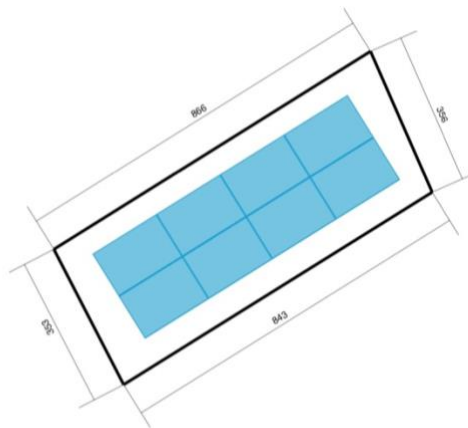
Dorfstrasse 4, Belegungsplan, Dachfläche 3: Dachaufbau Süd
